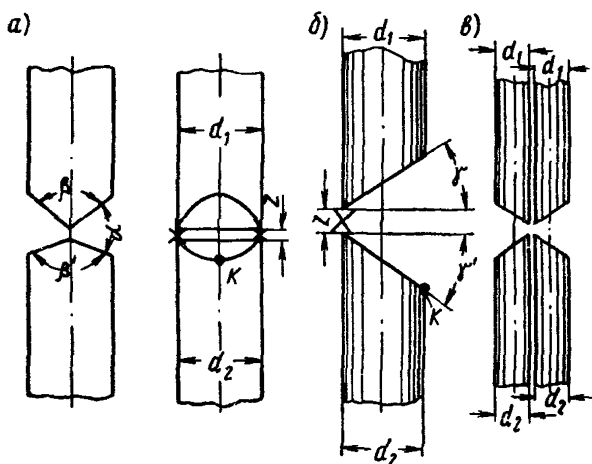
Разделка торцов вертикальных стержней для дуговой сварки многослойными швами без дополнительных технологических или конструктивных элементов
